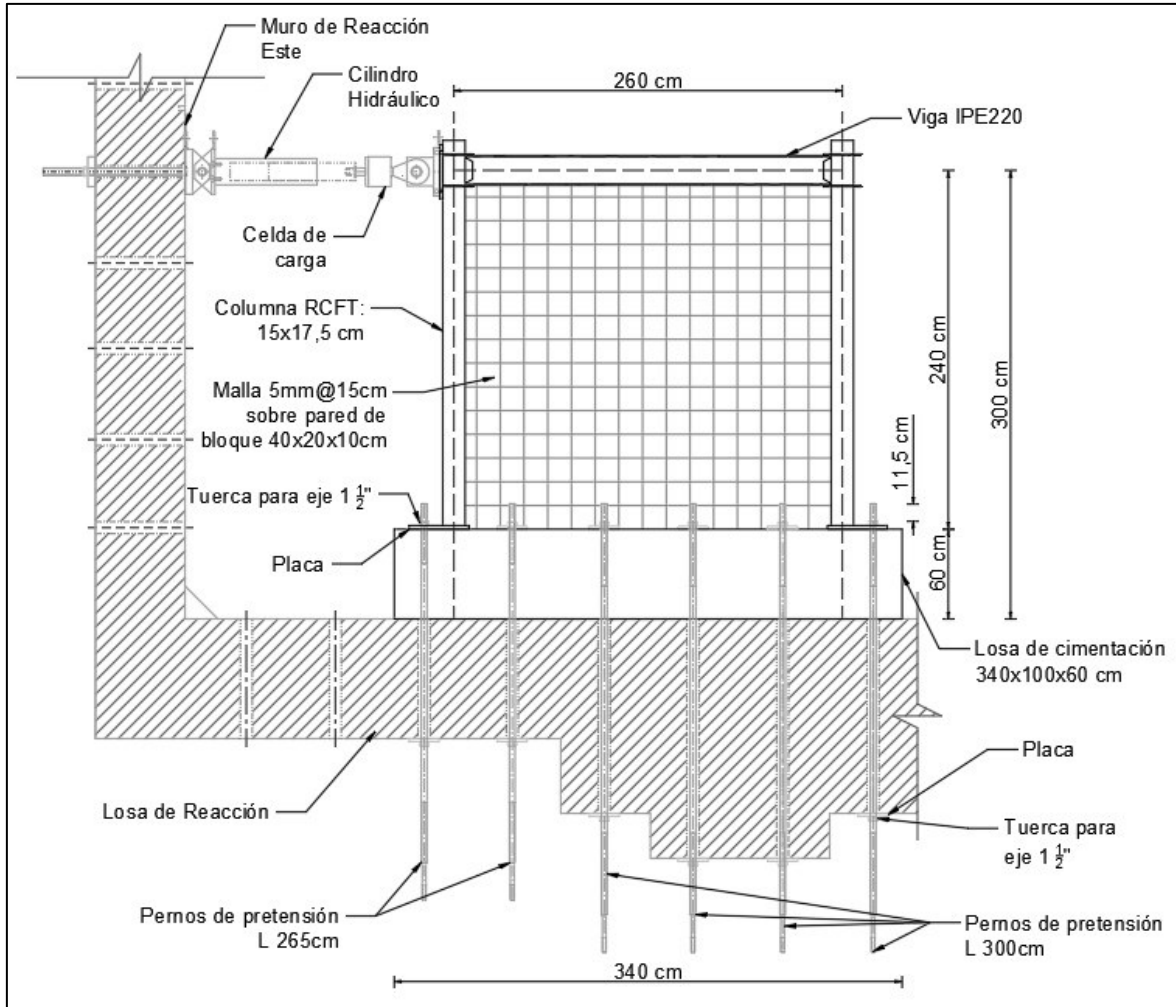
Detalles de Vista en Corte del Prototipo implantado en el CIV EPN.
